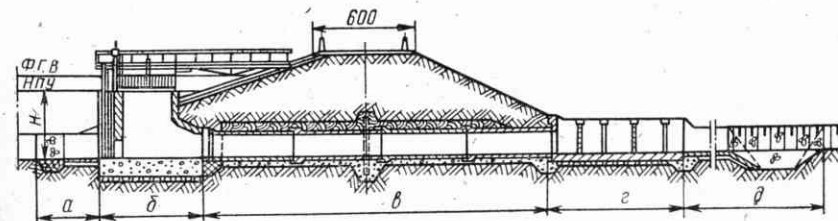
Шахтный водосброс из сборно-монолитного железобетона на расход до 30 м³/с (по типовому проекту 413—51 Киевского отделения Гидроробпроекта):
